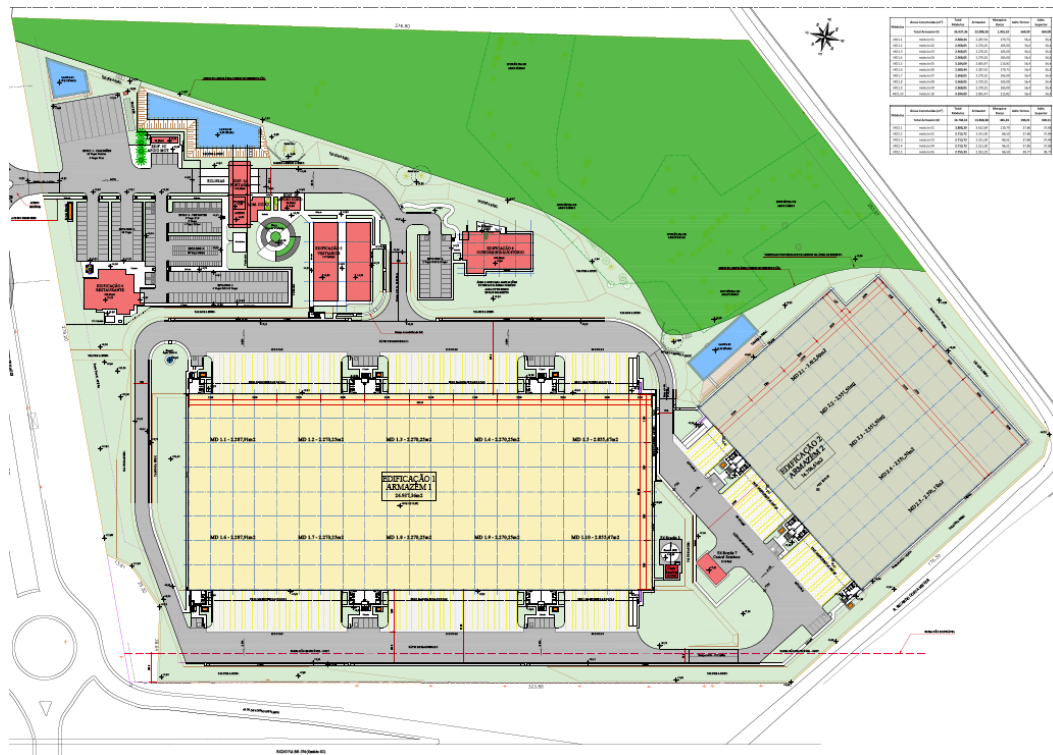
Planta Situação (Fonte: ArquiK Arquitetura)
